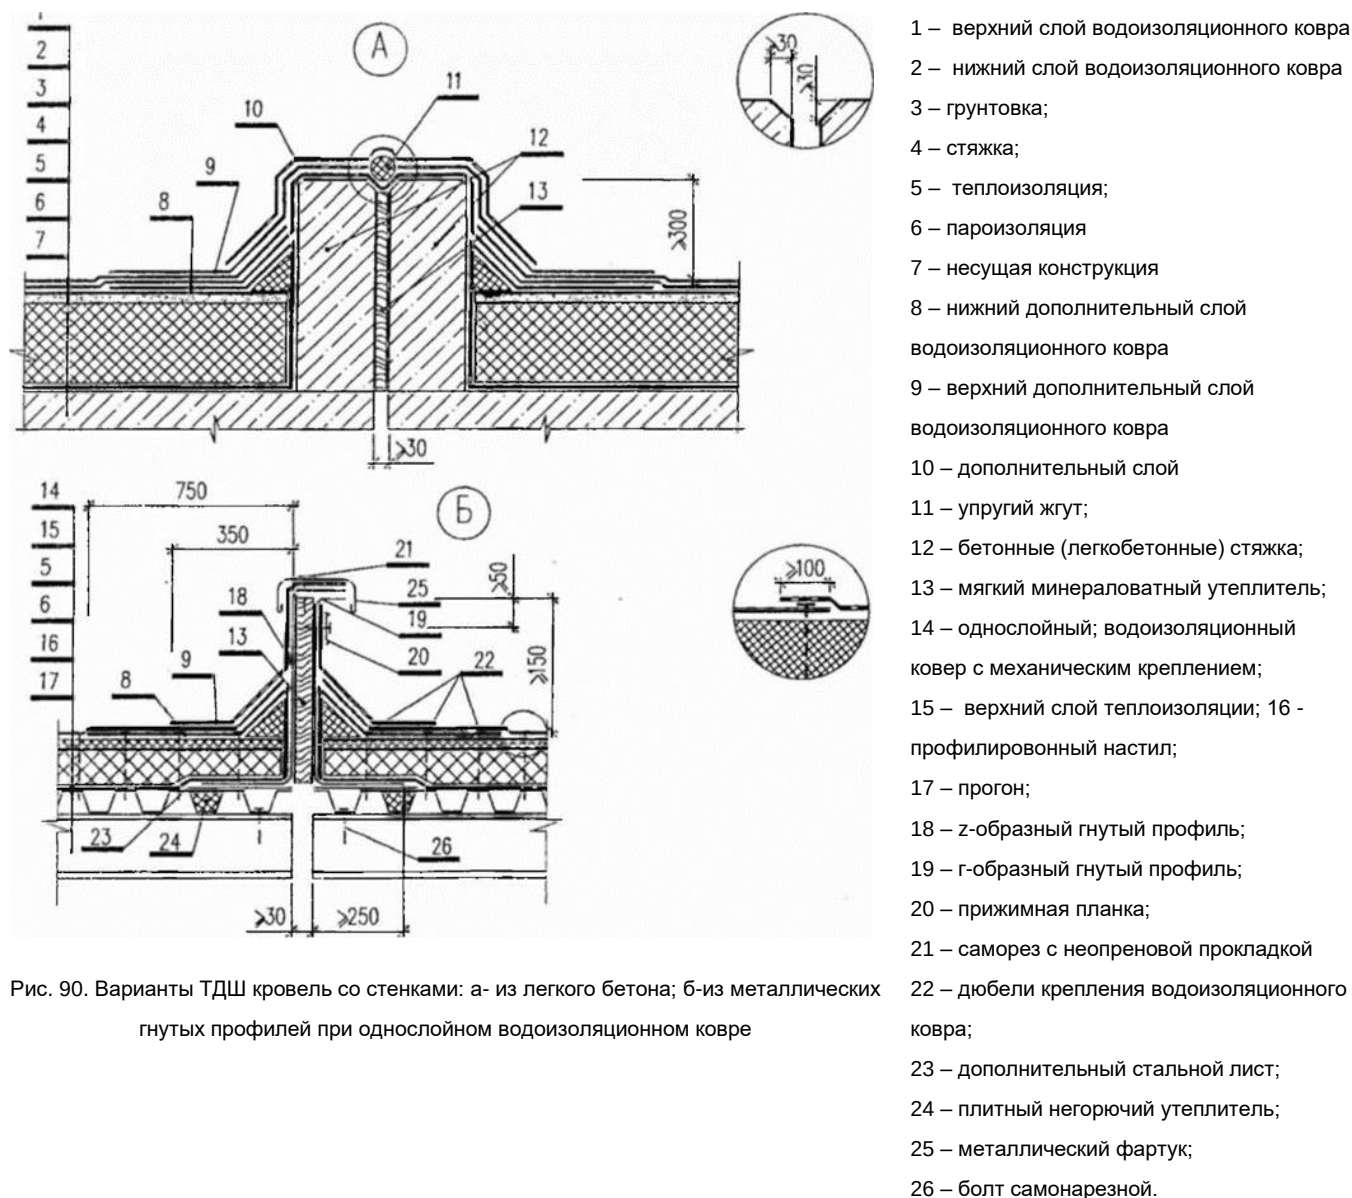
Варианты ТДШ кровель со стенками: а- из легкого бетона; б-из металлических гнутых профилей при однослойном водоизоляционном ковре
